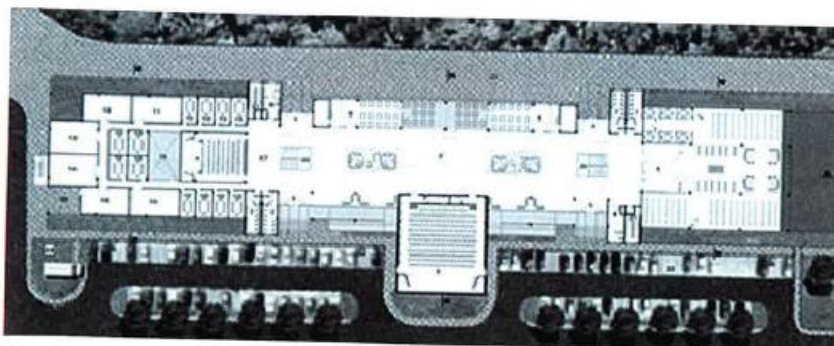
PLANTA TÉRREO DO BLOCO ACADÊMICO
